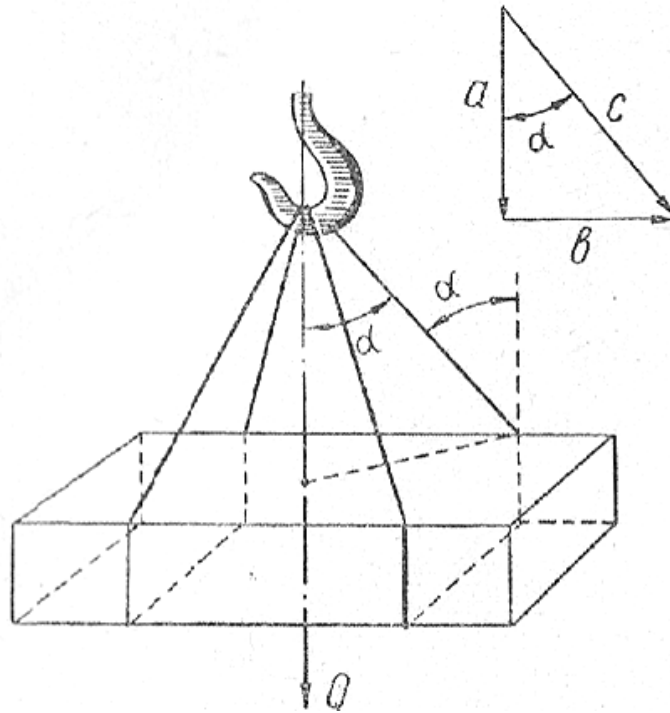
Схема к расчету нагрузки на ветви стропа
